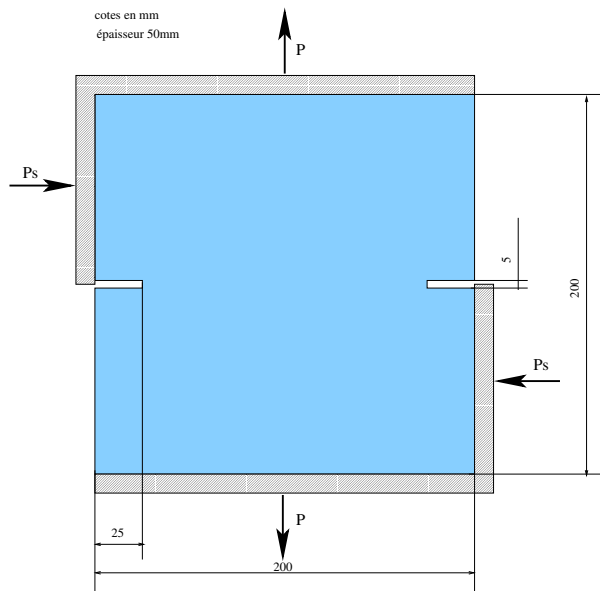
Corps d'épreuve essais de fissuration mixte
